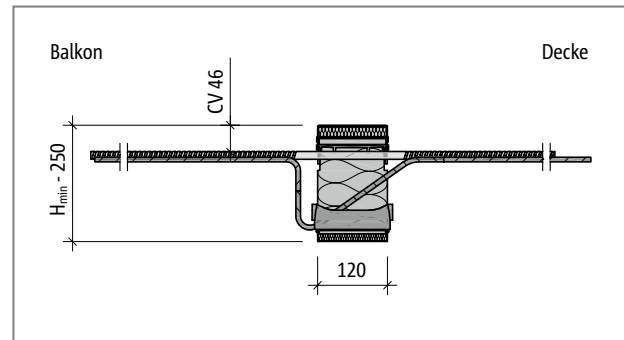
Schöck Isokorb® CXT Typ K bei Betondeckung CV46 (2. Lage): Produktschnitt
